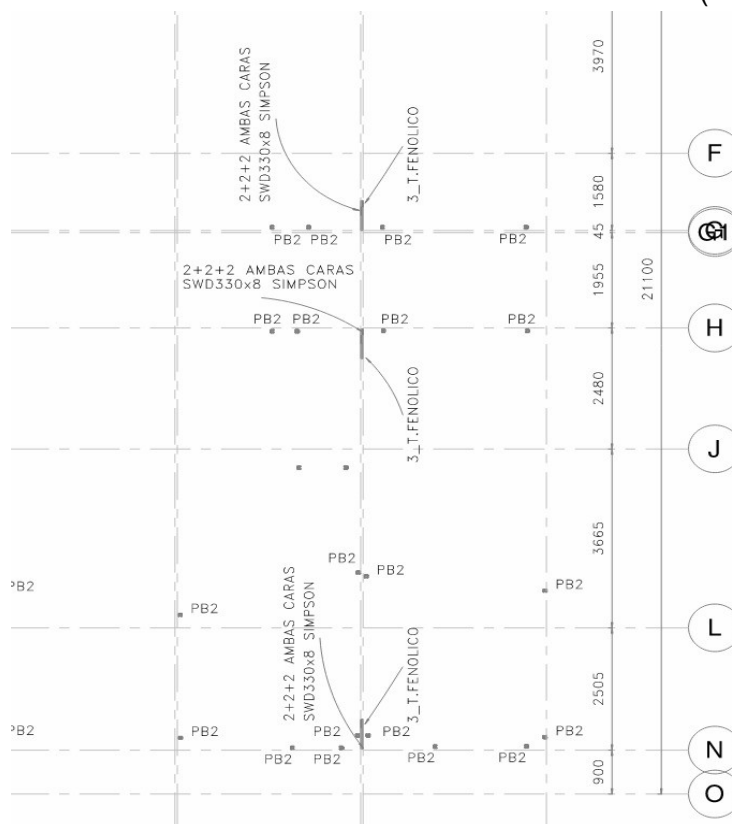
Detalle Planta disposición fijaciones. Fuente: Simpson Strong-Tie
